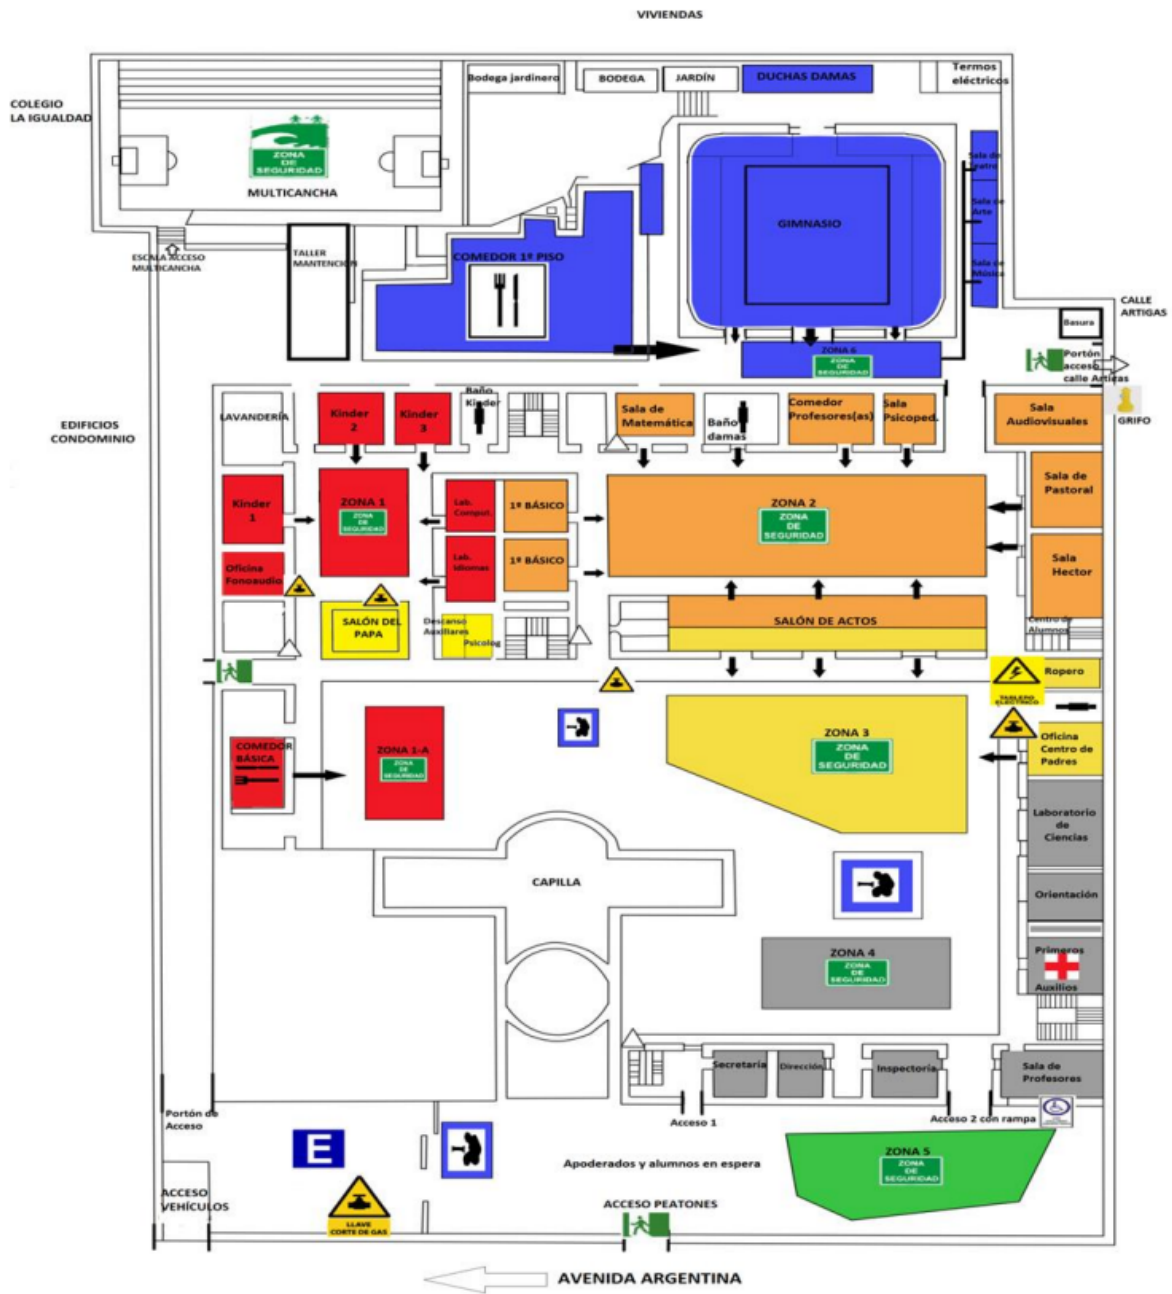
(VIAS DE EVACUACIÓN INTERNAS PLANTA 1º)
